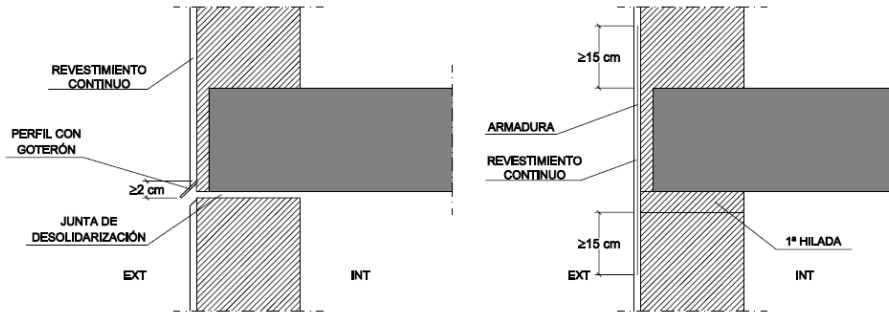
Ejemplos de encuentros de la fachada con los forjados
